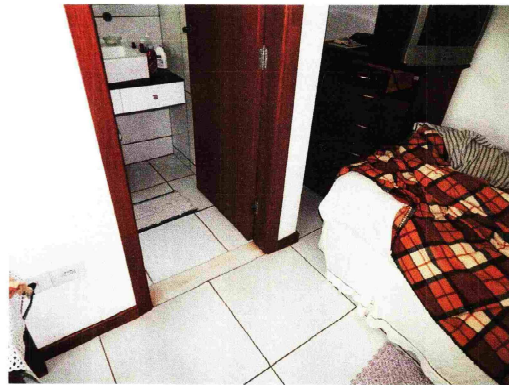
VISTA INTERNA QUARTO III - APTO
